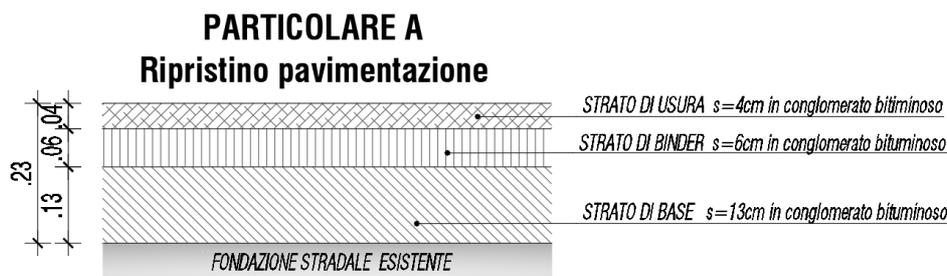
Pavimentazione ciclo-pedonale di progetto
